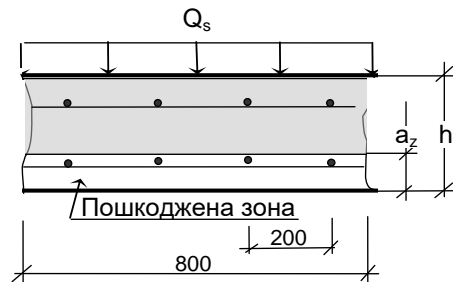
Універсальна розрахункова схема перерізу плити перекриття у перерізі між опорами та у перерізі над опорами.
